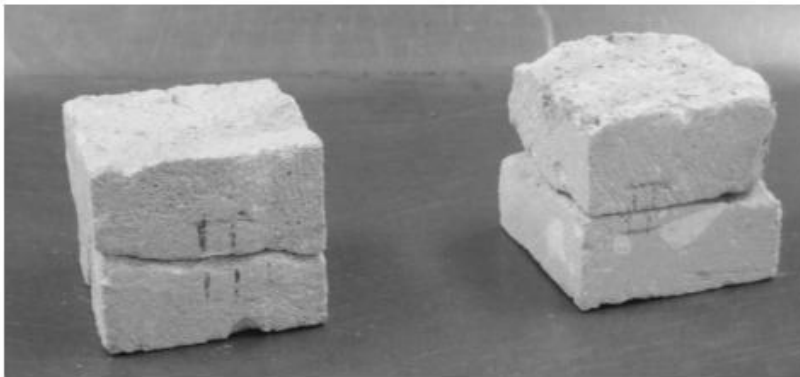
Пластины кладочного раствора, подготовленные для испытаний
